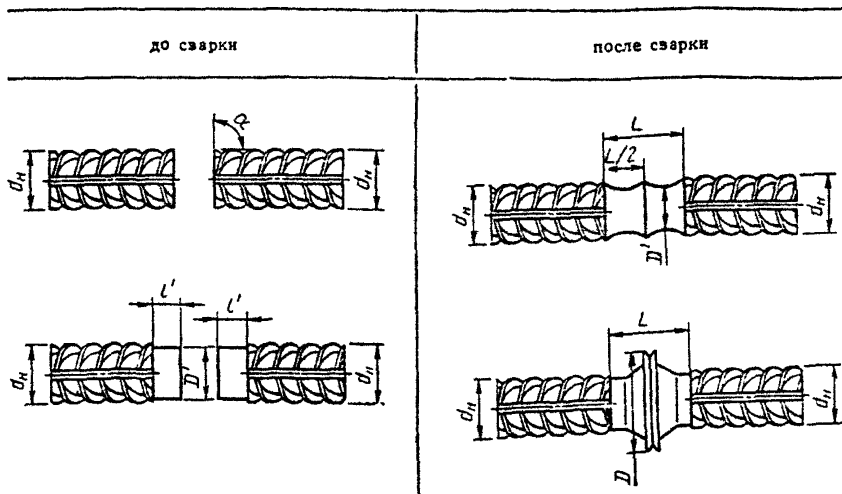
Конструкция стыковых соединений с механической обработкой после сварки (тип С3-Км) - сверху и до сварки (тип С4-Кп) - внизу
